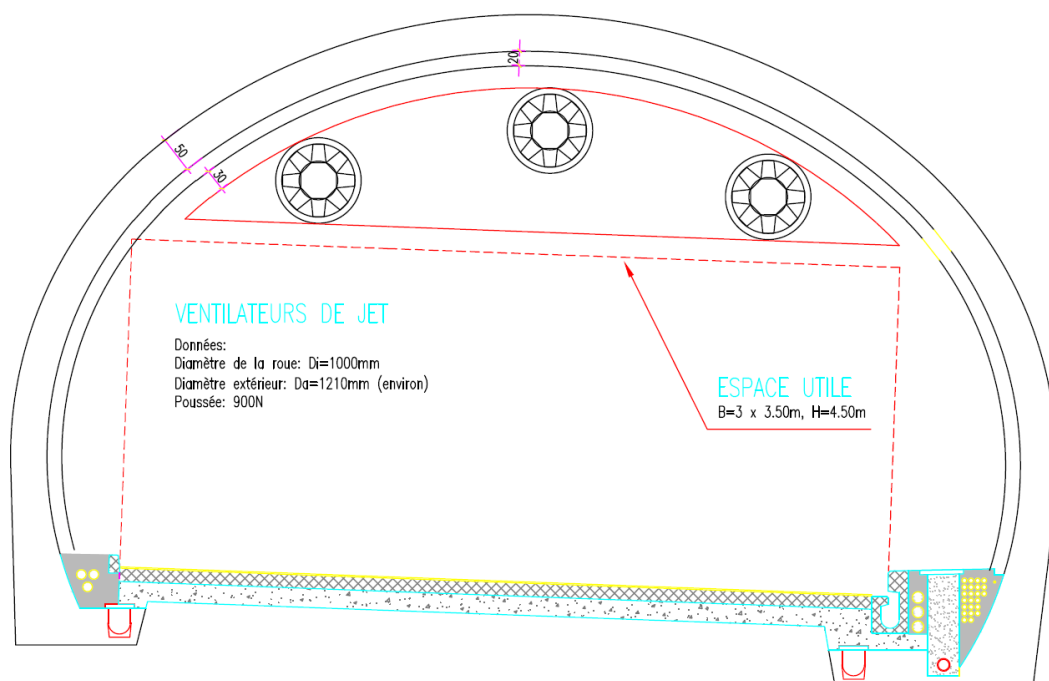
Coupe type du tunnel avec une batterie de 3 ventilateurs de jet de diamètre 1000 mm (hypothèse: 20 cm de revanche pour étanchéité du tunnel).
